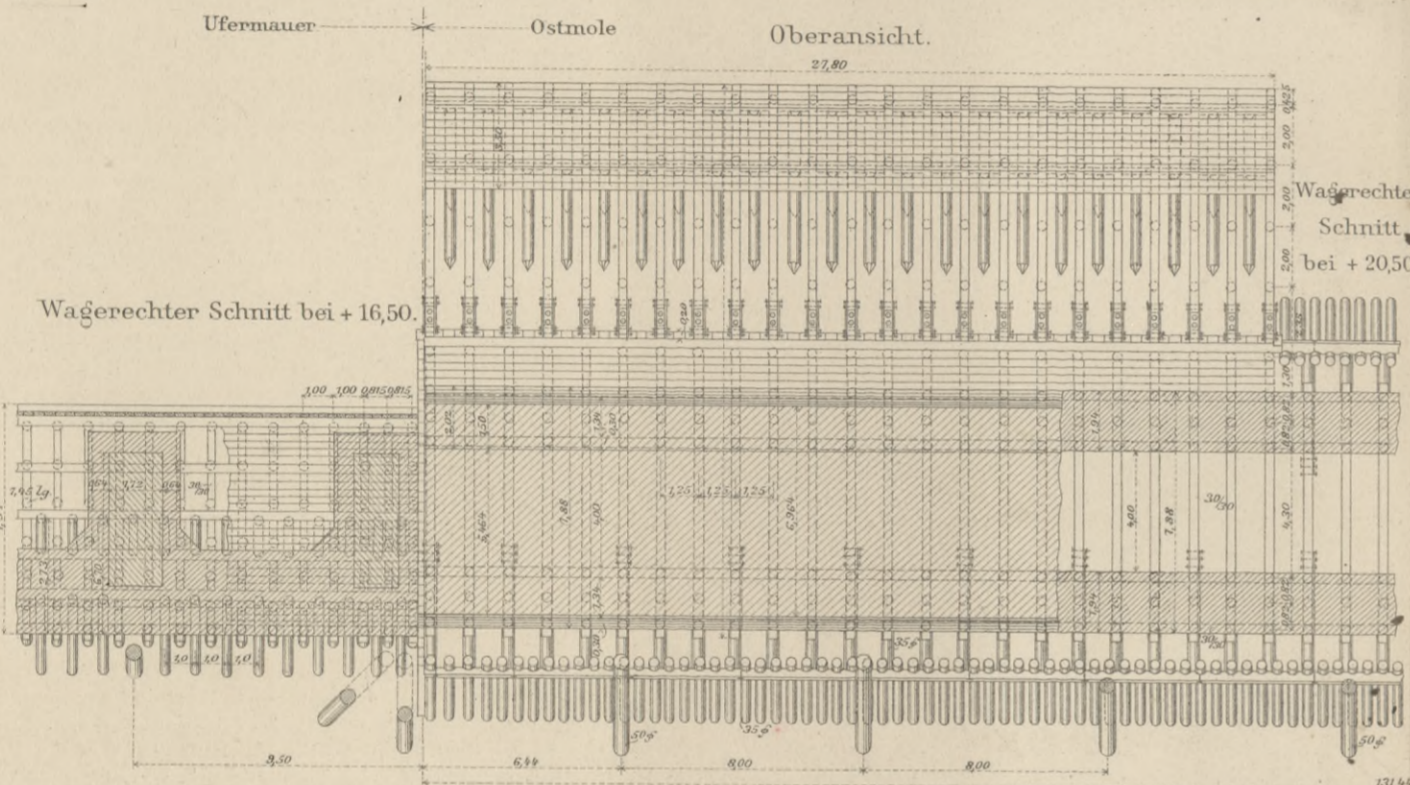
Grundriss u. Oberansicht der Ostmole und des anschließenden Theils der Ufermauer am Vorhafen in Brunsbüttel. 1:250.
